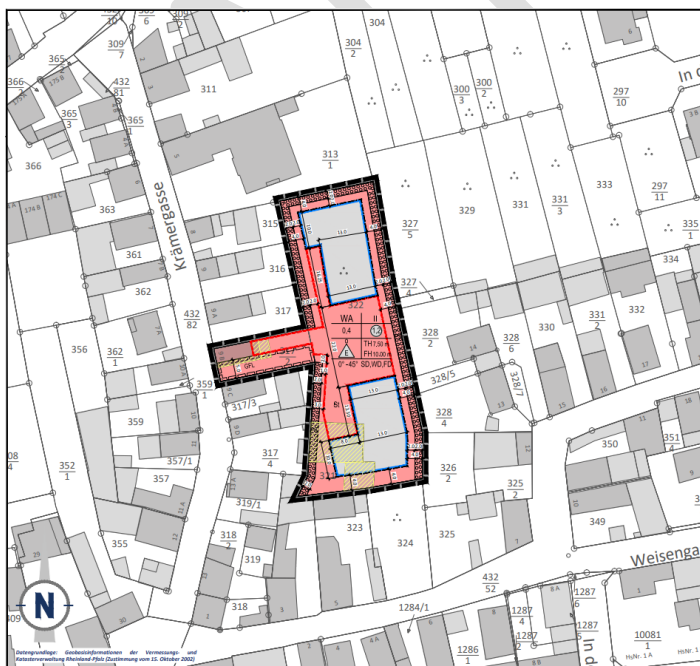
Entwurf des Bebauungsplans „Weisengasse- 3. Teiländerung und Erweiterung“
